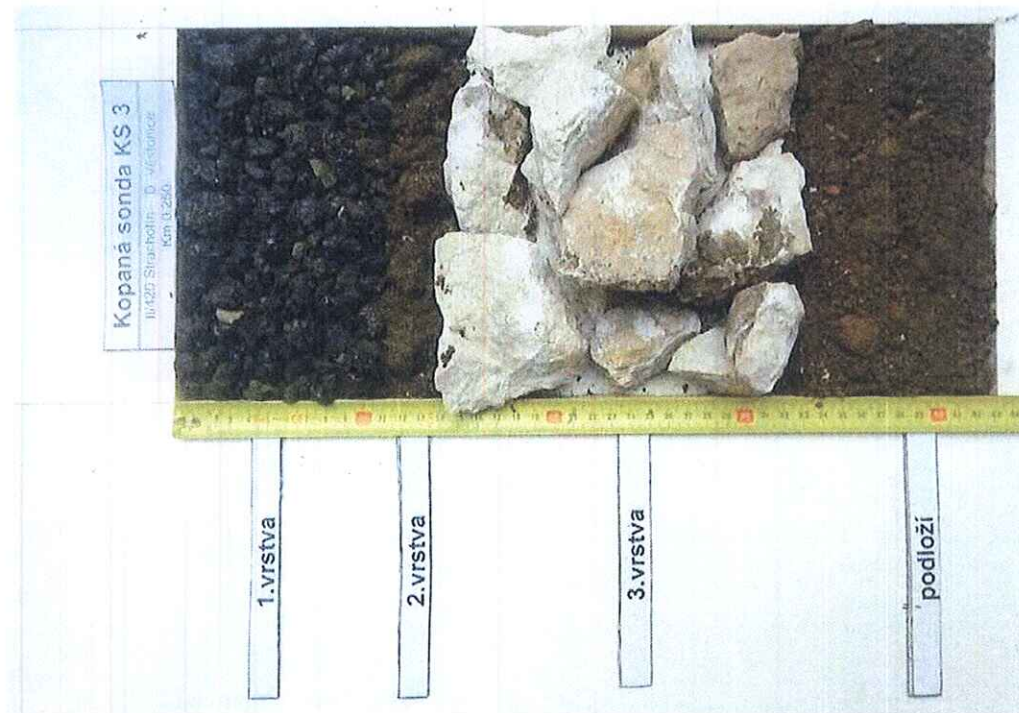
a č. 6 - Kopaná sonda KS 3
